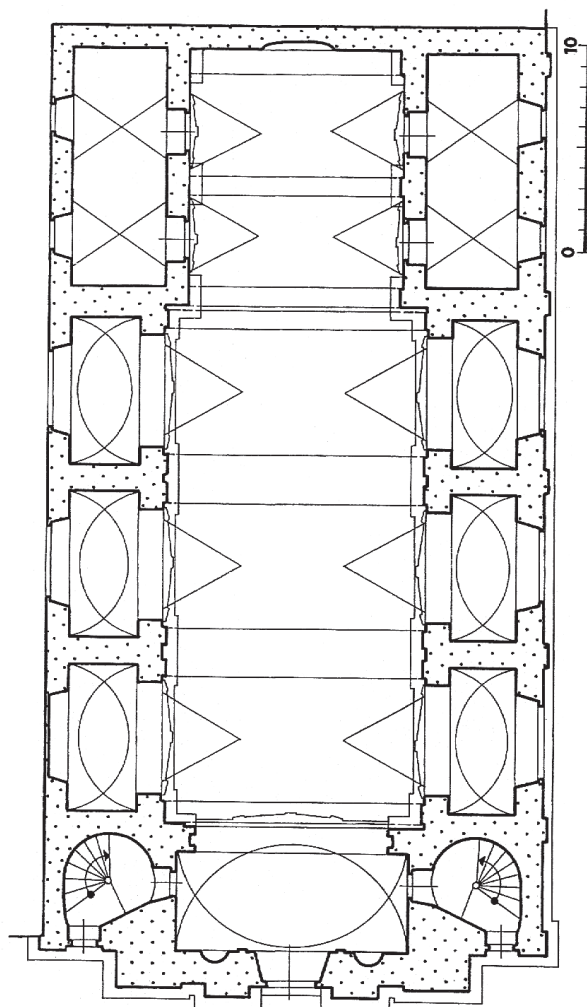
Iglau, Jesuitenkirche, Grundriß
